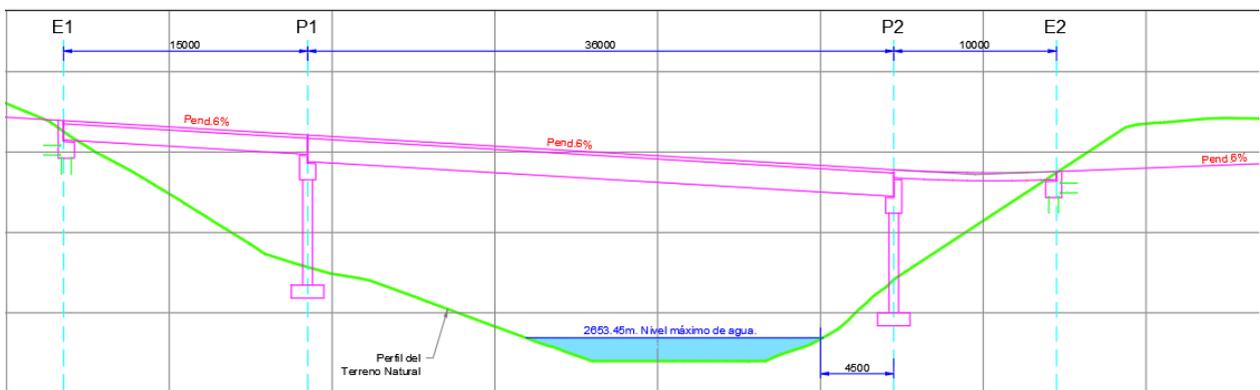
Alternativa estructural 1 [Elaboración propia]
